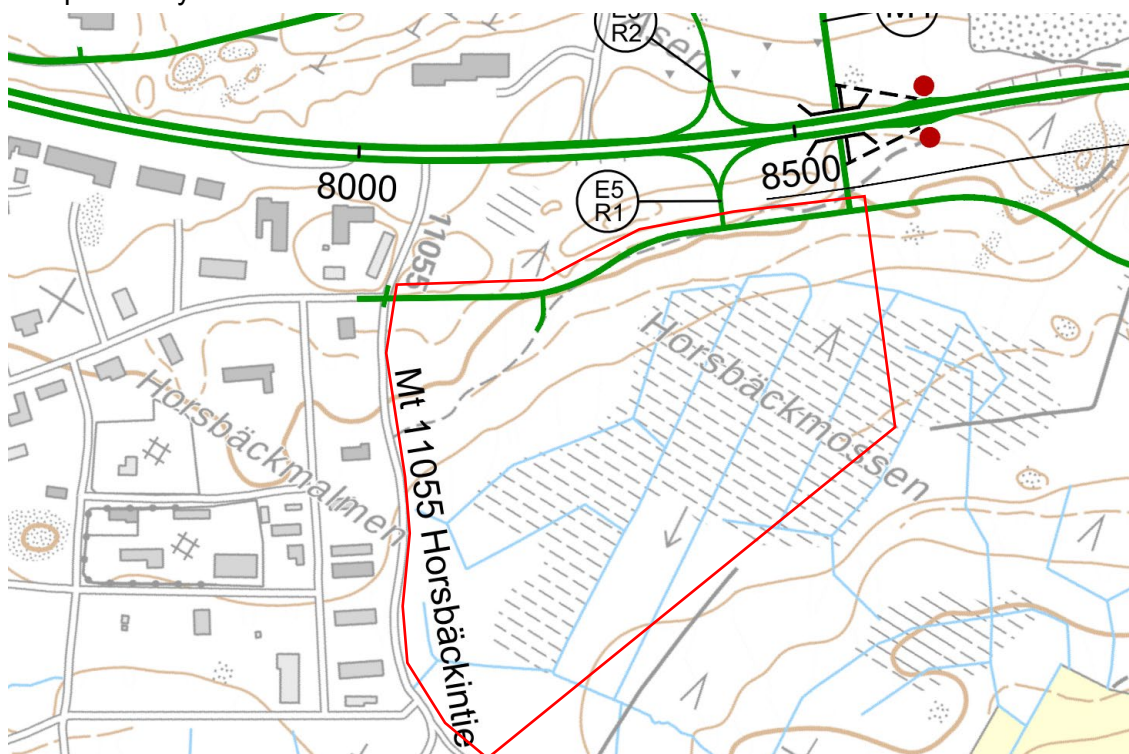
Planområdet på utdrag ur översiktskartan i utvecklingsutredningen. (Sitowise, 2022)
